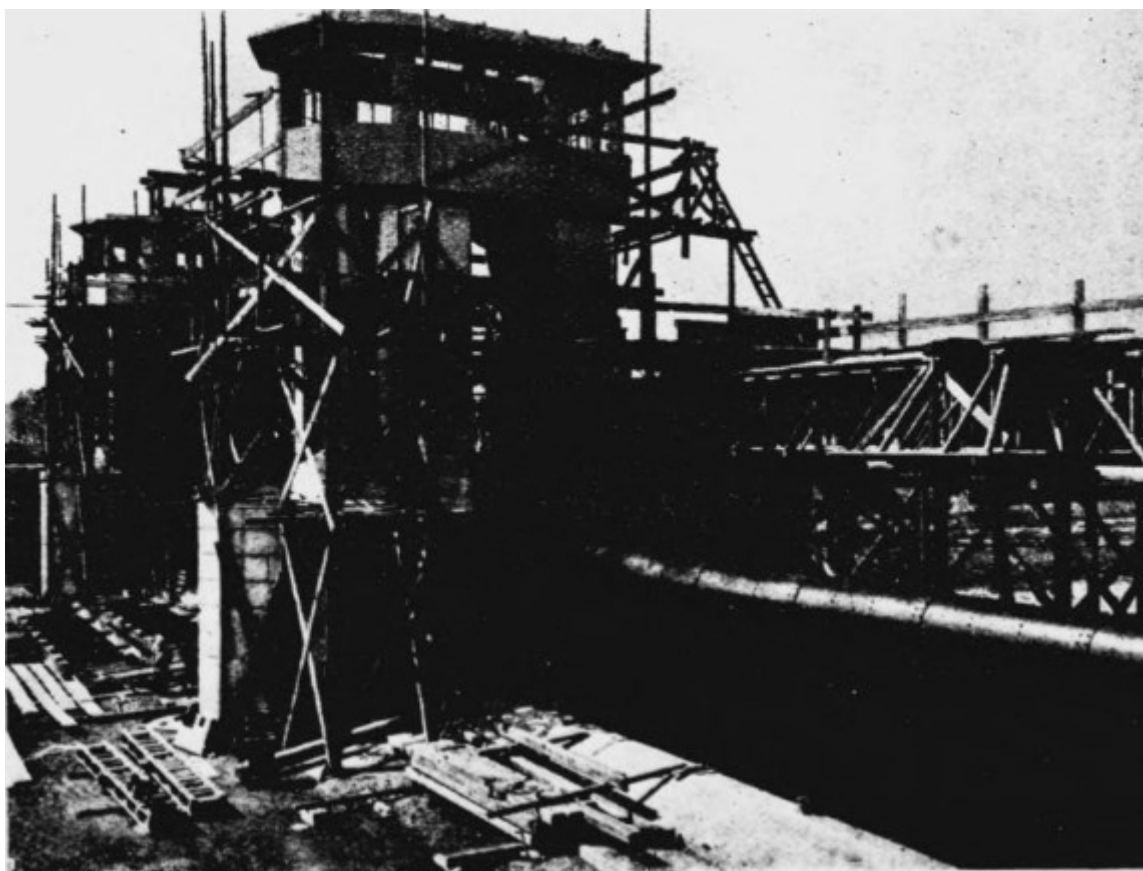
Poděbrady stavba jezu pravostranný pilíř a hřbet jezový, *Technický obzor* 1916 Tab. 34.
